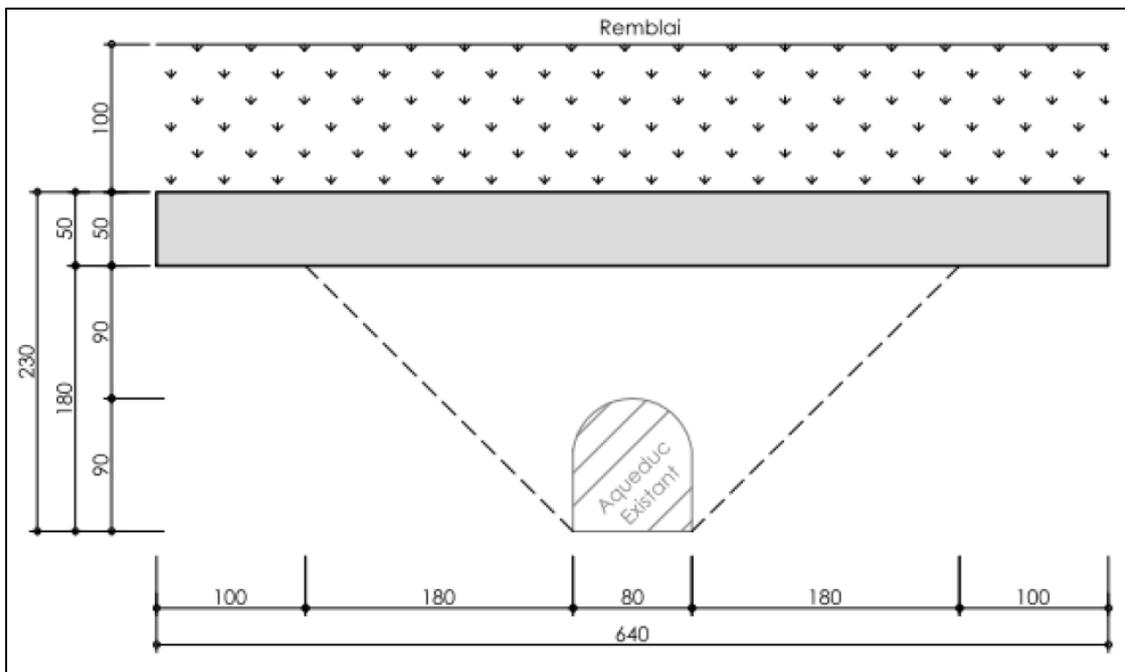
Schéma de la dalle béton mise en place pour la mise en protection de l'aqueduc (Source : Sodeba Ginko)
